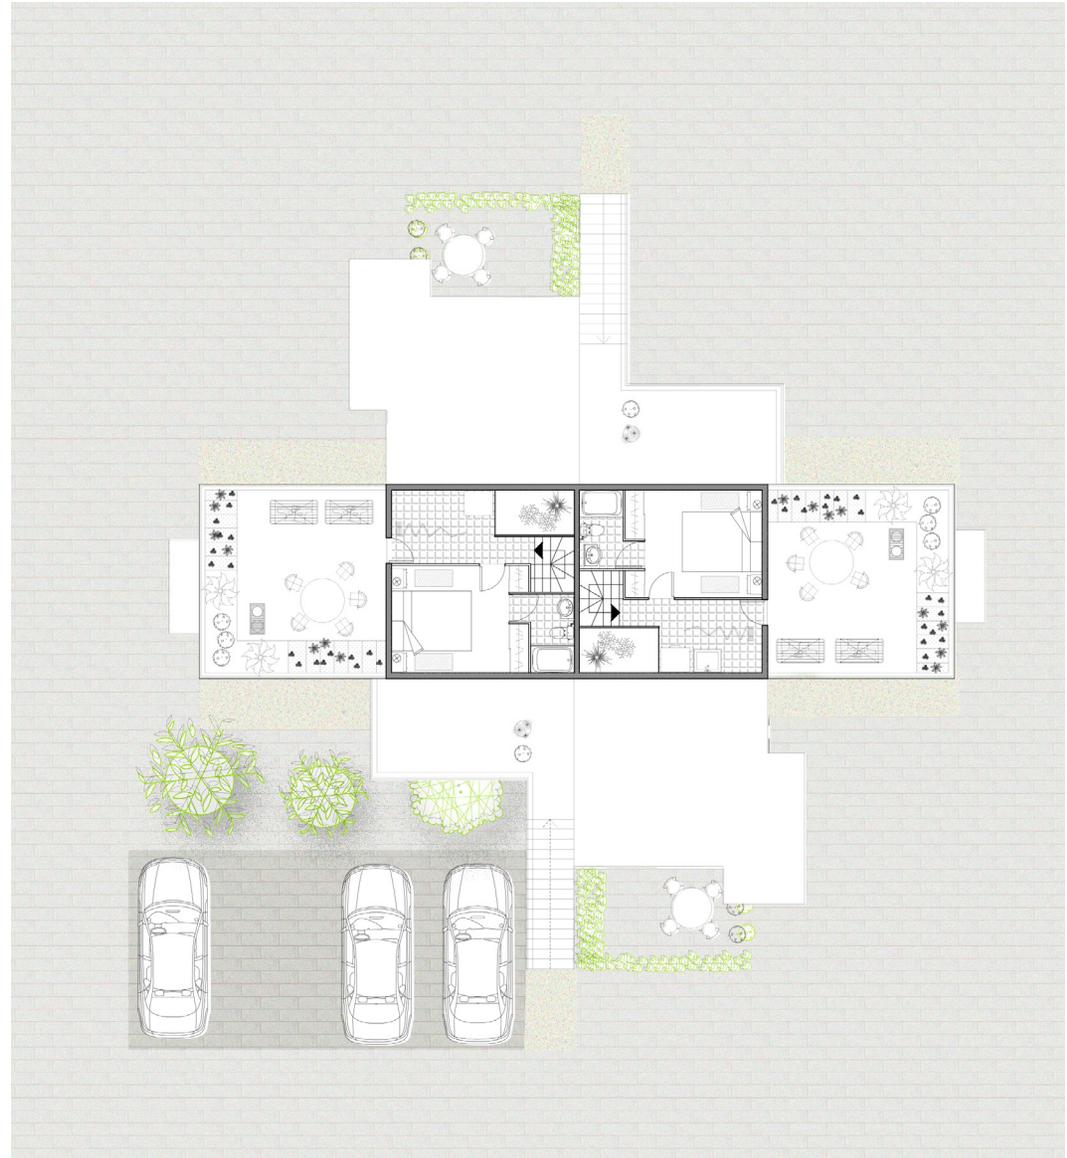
Planta propuesta unidad habitacional, tercer piso, avance proyecto
